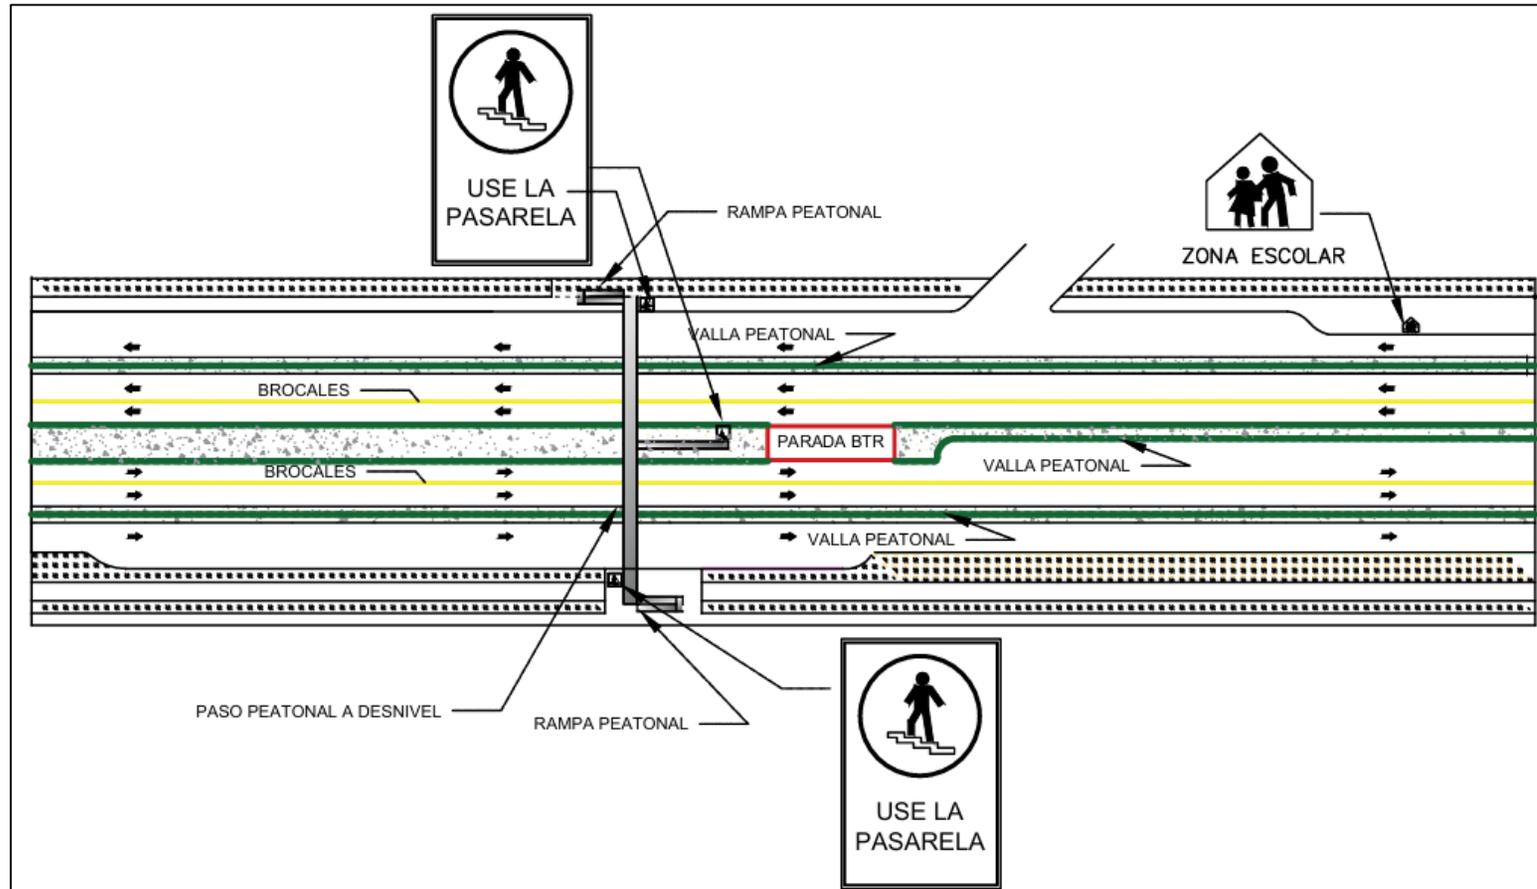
Vista de planta de la zona en estudio con propuesta aplicada
